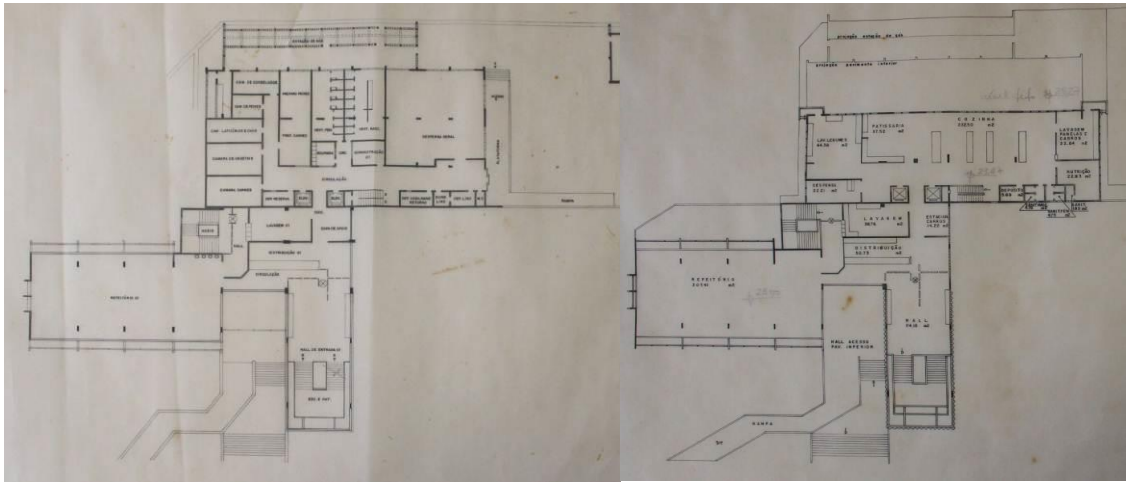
Planta Pav. Térreo RU (projeto construído), 1978. Fonte: Acervo SUMAI
